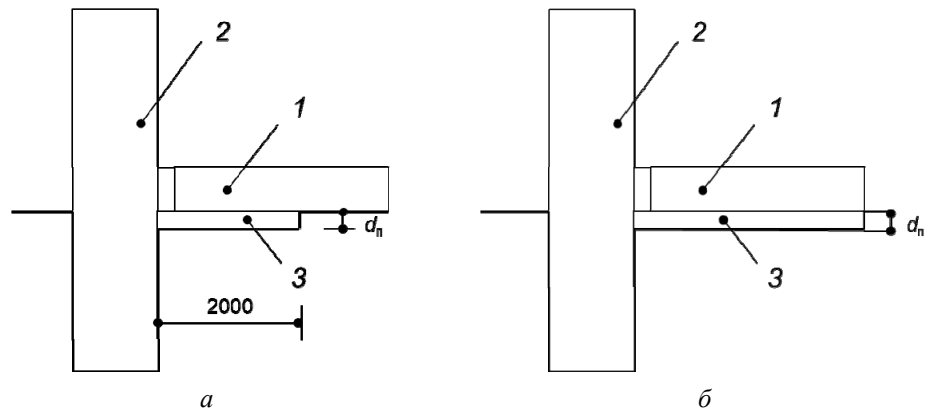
Схемы теплоизоляции краевой зоны плиты пола (*а*) и всей плиты пола (*б*): 1 — плита пола; 2 — стена фундамента; 3 — утеплитель;  $d_n$  — толщина изоляции
